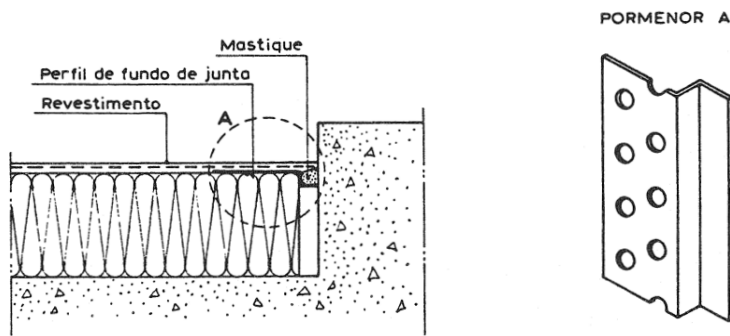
Junta dessolidarizante do sistema relativamente a um elemento saliente rígido da construção [2]
